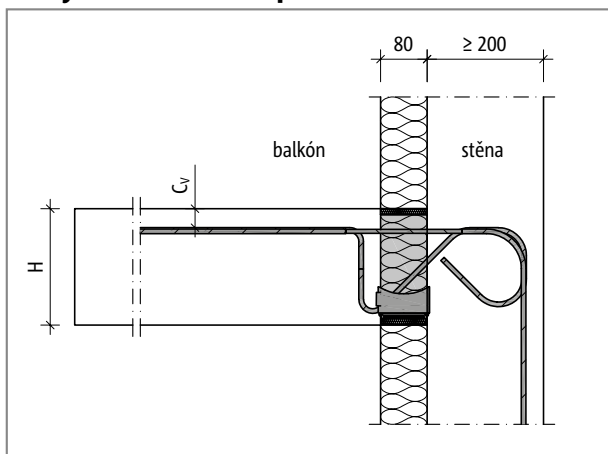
Schöck Isokorb® T typ KL-BH: Balkón zvýšený oproti stropní desce, vnější zateplení
